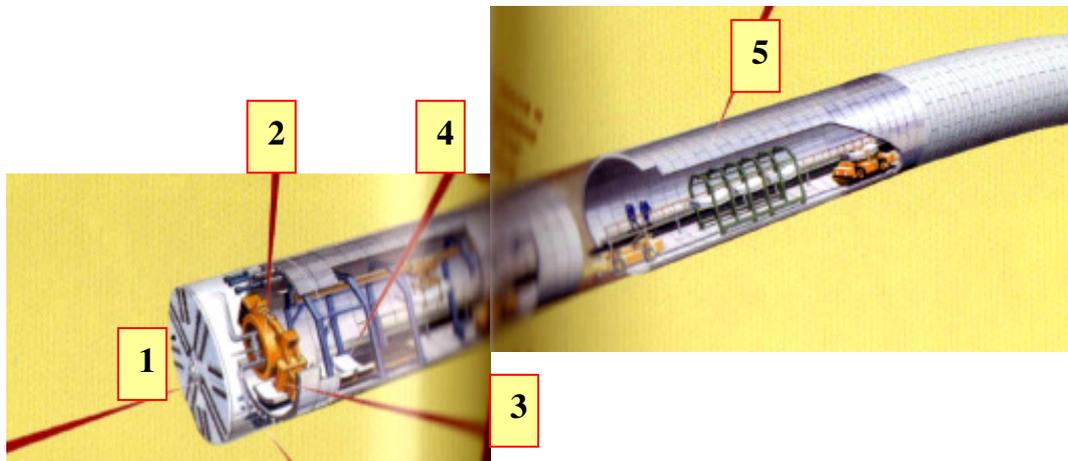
Arbeitsweise beim Tunnelausbau mit einem Erddruckschild
